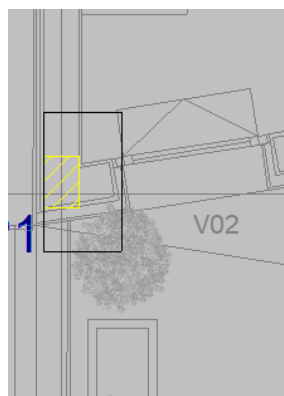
Sapata do Pilar P1 (Fonte: CYPE)
